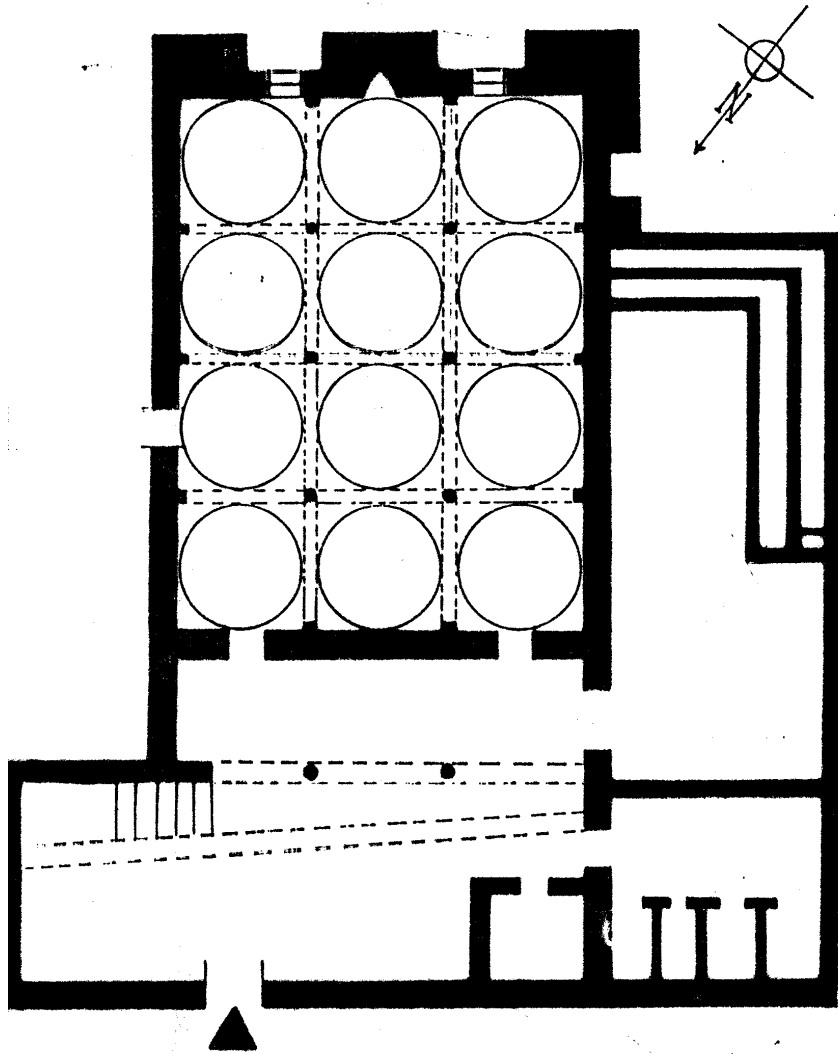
مسقط أفق للتخطيط الأصلي لجامع شاذلي العين
